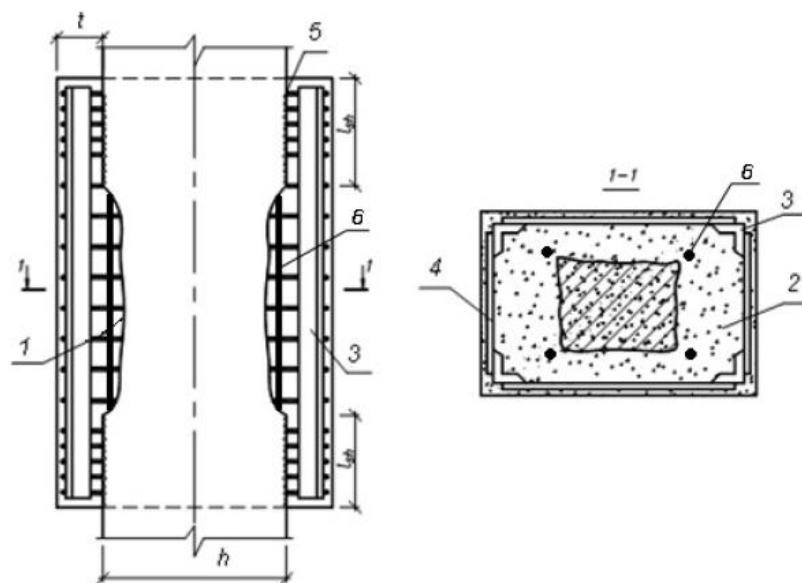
Усиление участка колонны местной железобетонной обоймой
